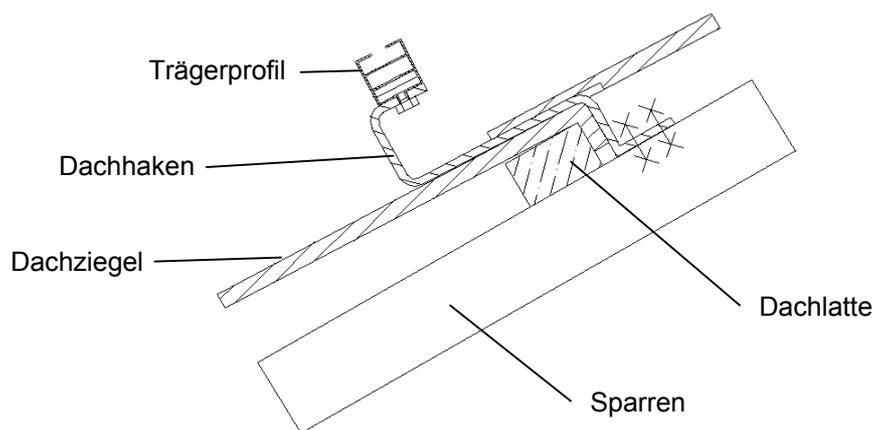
Befestigung eines Trägerprofils am Dachhaken mittels Hammerkopfschraube
